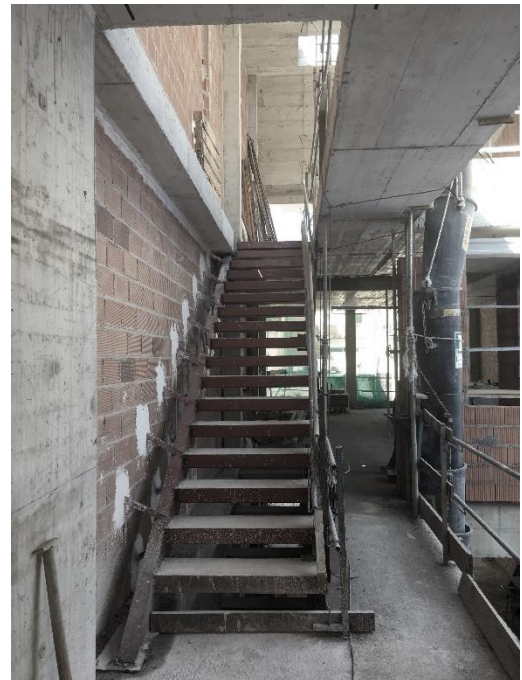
Escalera del tramo de planta primera, dinteles de hormigón prefabricado y pared medianera del fondo.
